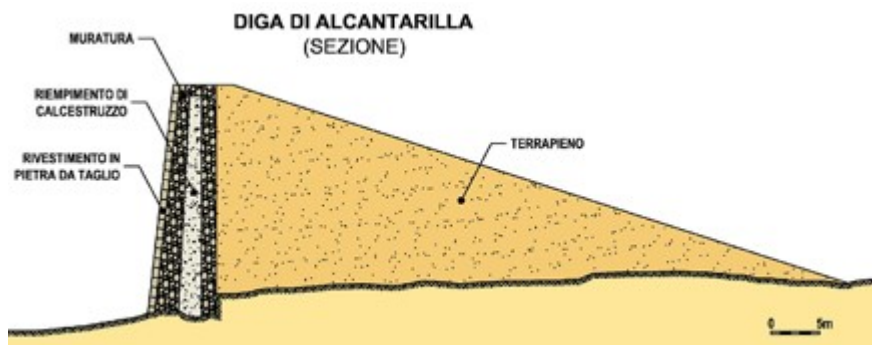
Sezione della diga di Alcantarilla (fonte: [www.dgdighe.mit.gov.it](http://www.dgdighe.mit.gov.it)).
